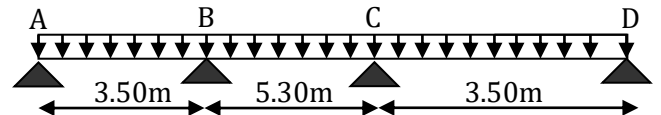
Schéma statique d'une Poutrelle : Type -4- étages courants
